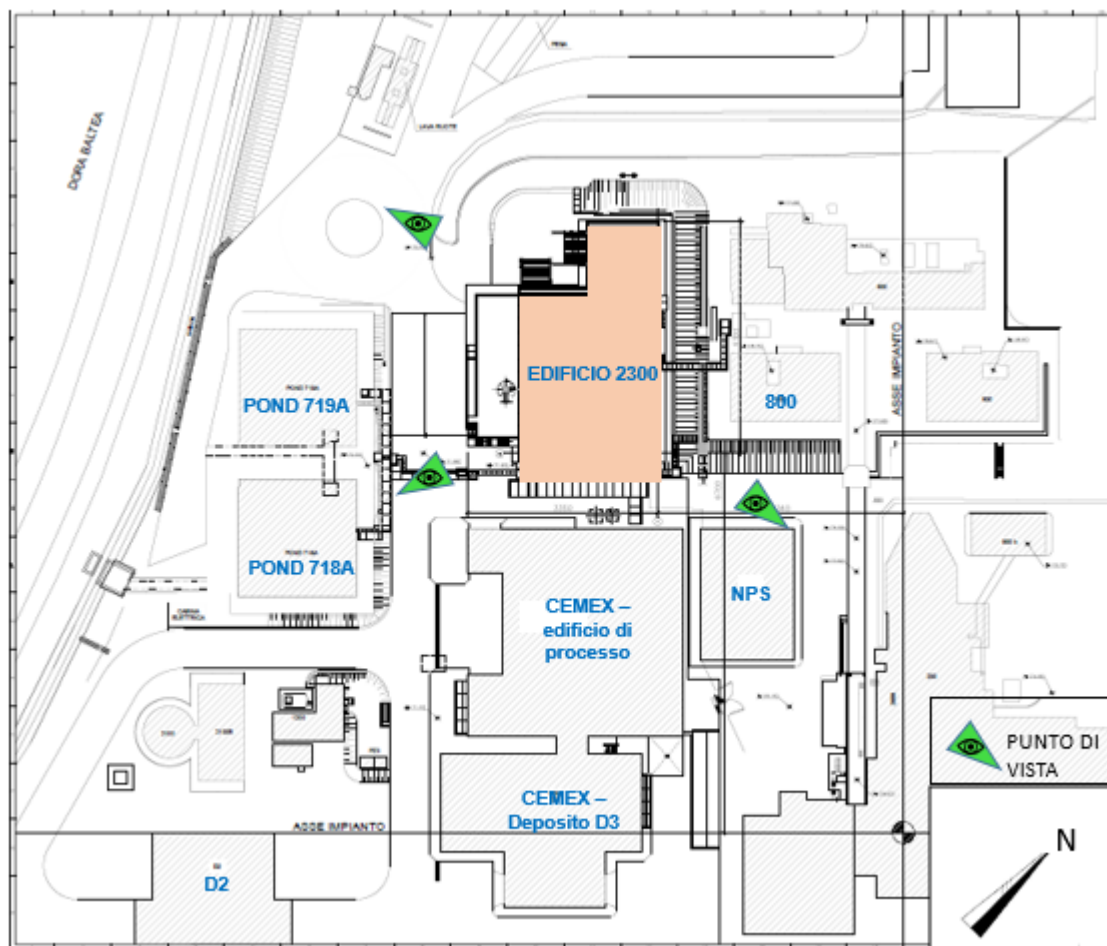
Planimetria del sito Eurex – dettaglio zona edificio 2300 ed edifici limitrofi
